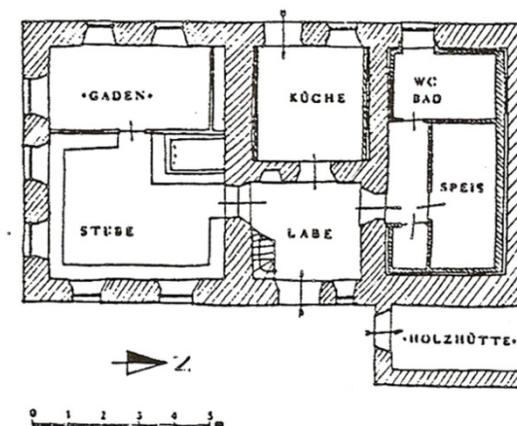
Mittellabengrundriss, 16.-17. Jahrhundert
